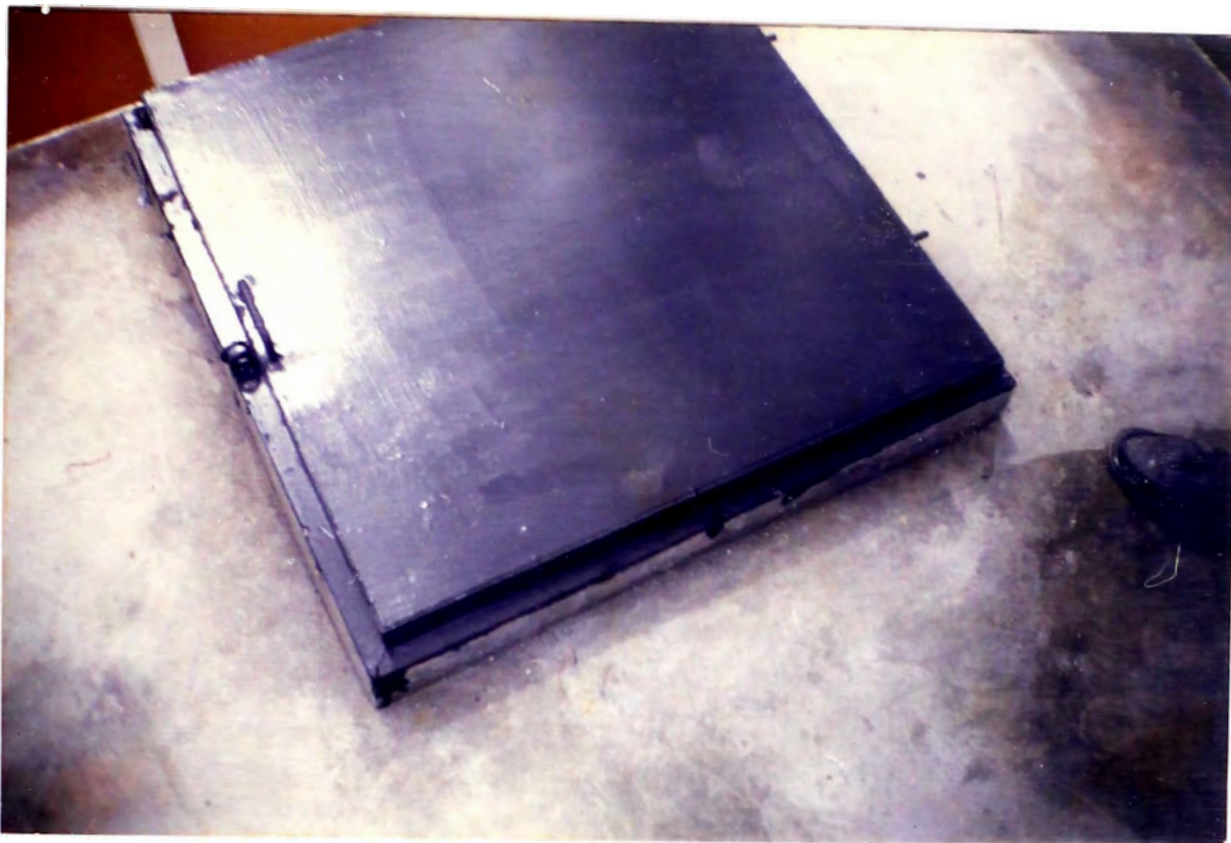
En esta foto se ve la tapa del Tanque Elevado completamente terminada e instalada.
